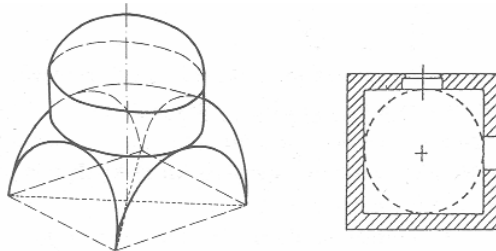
Kroužená klenba – příklad kresby v půdorysu
